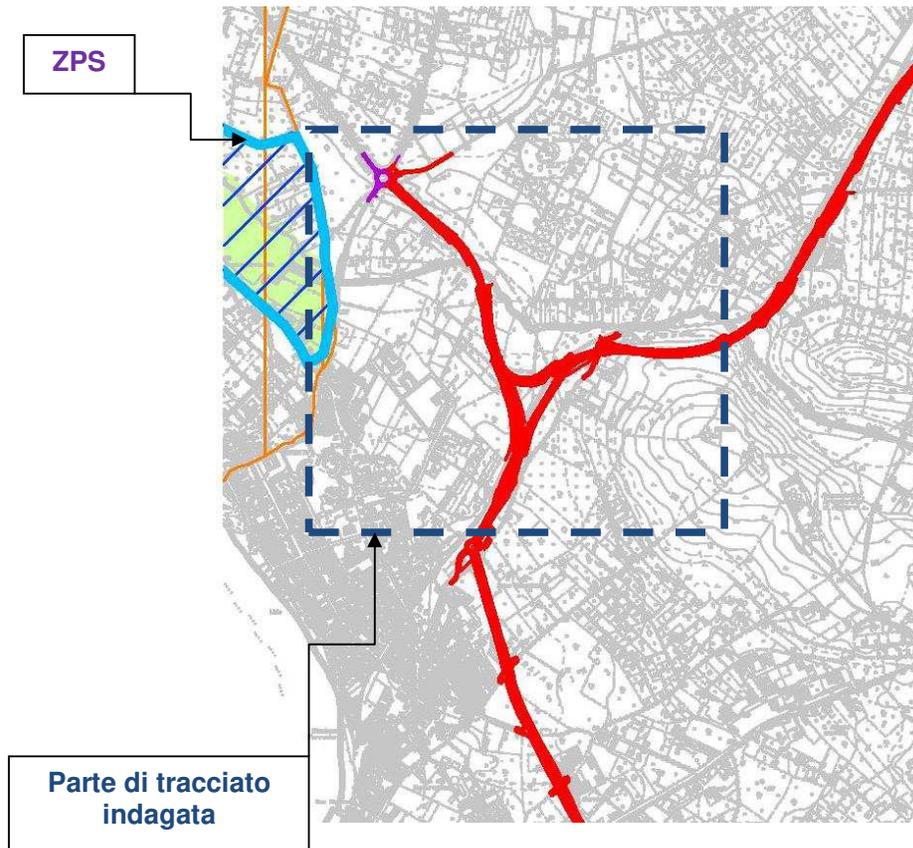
Planimetria di cantiere con evidenziata area ZPS e parte di tracciato indagata
